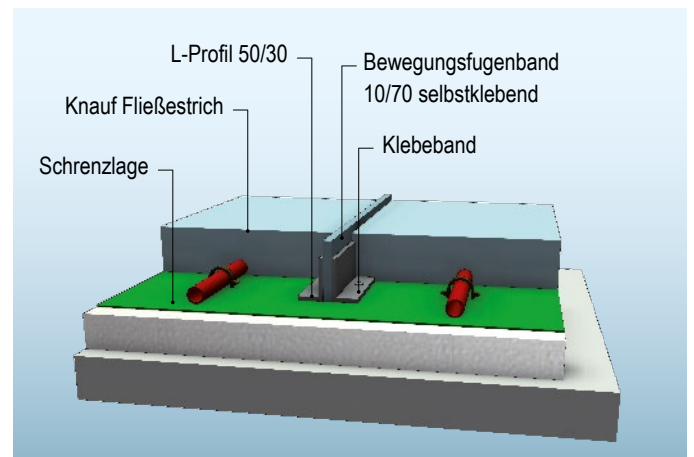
Ausführungsvariante 3: Fugen mit L-Profil
